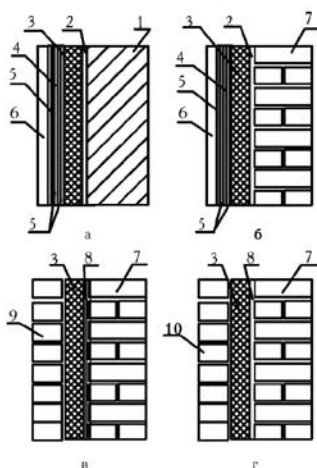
Технические решения многослойных теплоизоляционно-облицовочных систем для стен, разработанные в КиевЗНИИЭП: а) внешняя теплоизоляционно-облицовочная система на основе пенополистирола со штукатуркой на минеральной или органической основе для установления на панельные стены (при реконструкции или новом строительстве); б) то же самое, для установления на кирпичные стены или стены из мелкоштучных камней; в) с облицовкой лицевым кирпичом с расшивкой швов; г) с облицовкой лицевыми мелкоштучными камнями с эффектом расшивки швов
